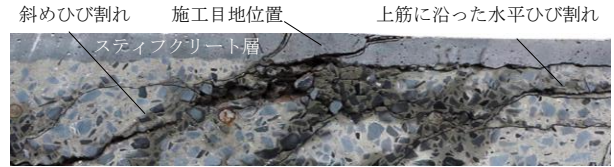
床版断面のひび割れ状況(拡大)
